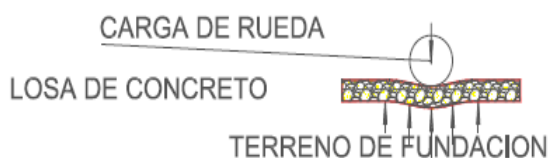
Transferencia de carga de una rueda en una estructura de pavimento rígido
